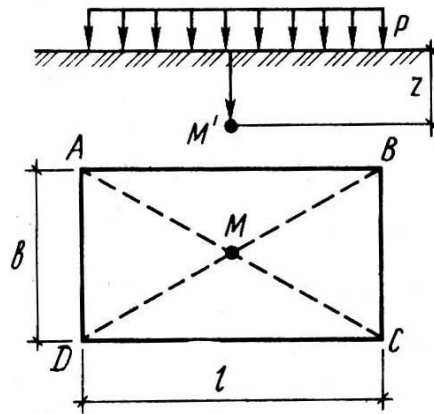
Схема к определению напряжений от произвольной распределённой нагрузки
